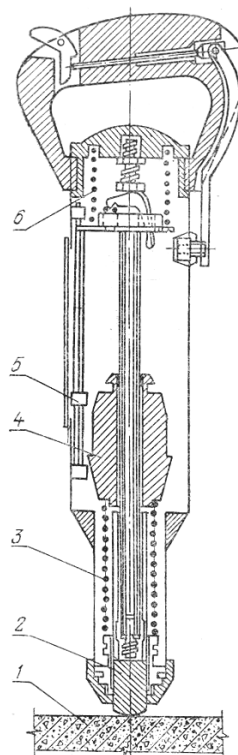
Пружинный прибор КМ: 1 – поверхность испытываемой конструкции; 2 – сменный ударник; 3 – ударная пружина; 4 – боек; 5 – шкала с указателем величины отскока бойка; 6 – возвратная пружина
